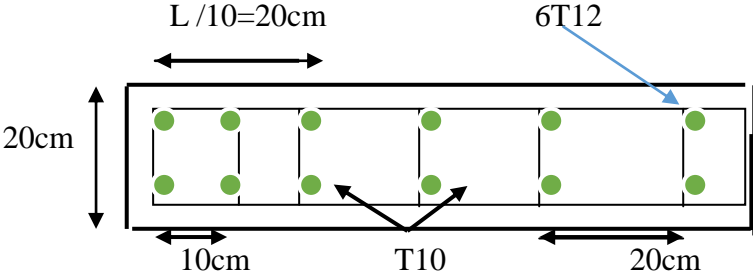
SCHEMA DE FERRAILLAGE (1/2voile)
